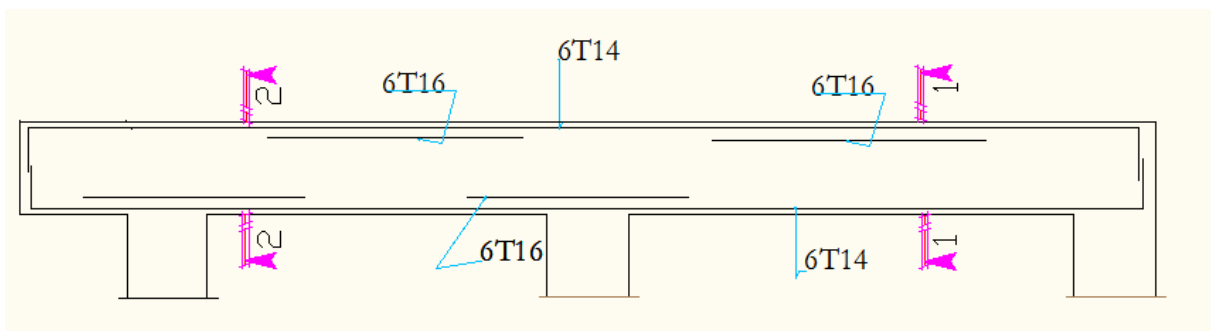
schéma de ferrailage de la poutre de rigidité
